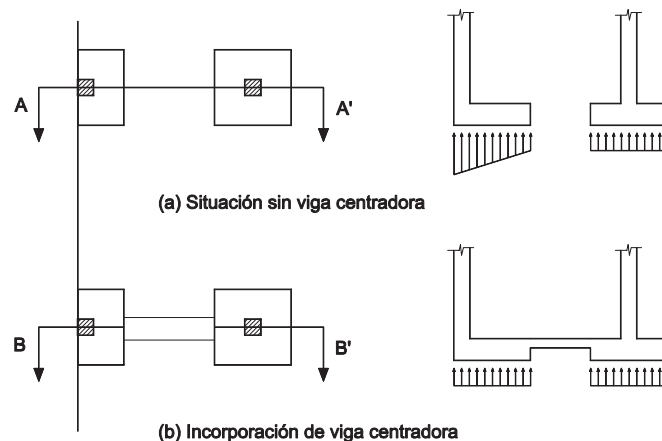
Ejemplo del empleo de vigas centradoras para redistribución de presiones sobre el terreno
